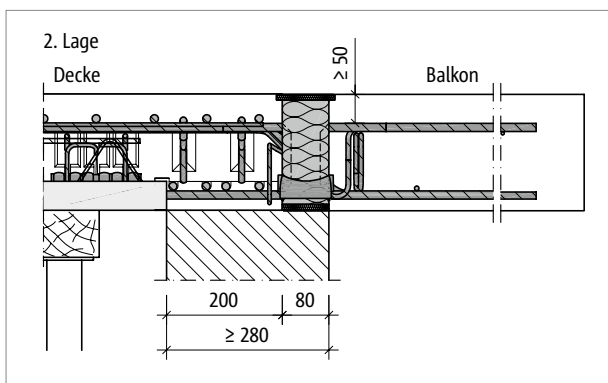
Schöck Isokorb® T Typ C: Halbfertigteilplatte mit Randunterstützung mit wärmedämmendem Mauerwerk (Schnitt T Typ C-CV50-2. Lage, Ansicht T Typ C-CV35-1. Lage)
